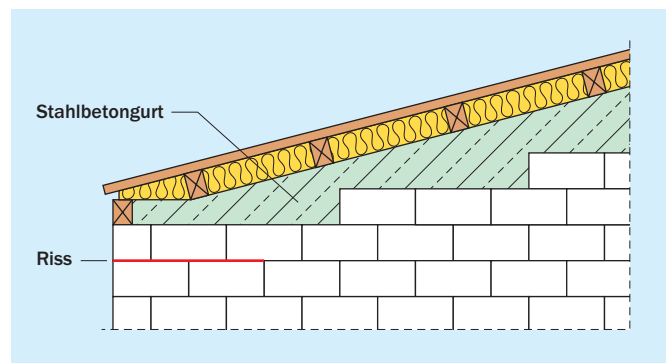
Stahlbetongurt auf Mauerwerks-Giebelwand
